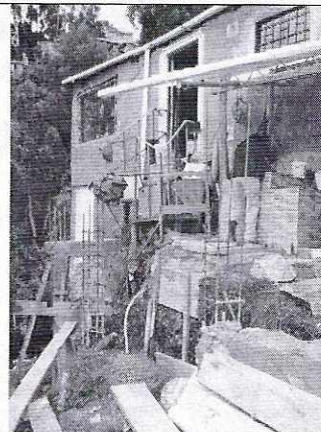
Fachada lateral. Estructuras de contención del terreno en proceso de construcción. No se observa daños
